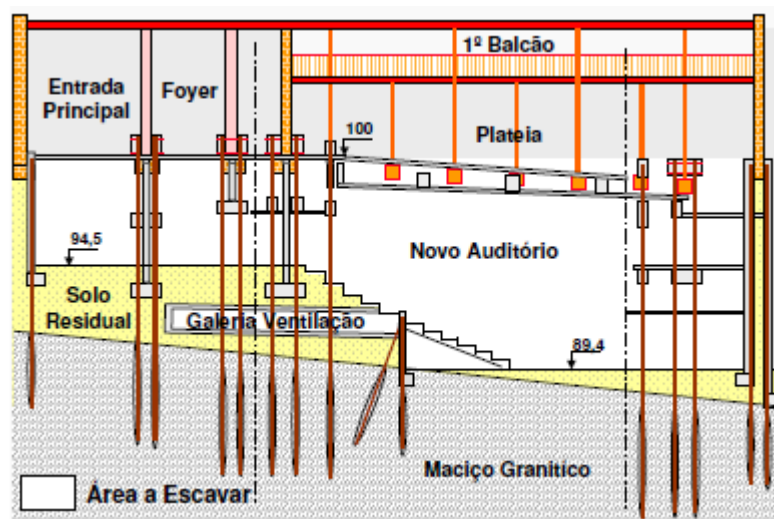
Corte longitudinal 1-1 representado no esquema da planta [68]
